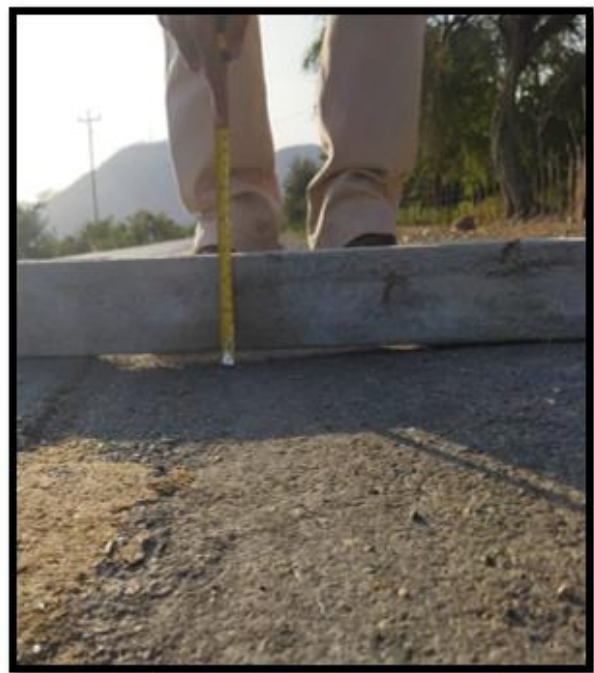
Toma fotográfica de la falla Tipo Abultamiento y Hundimiento en el pavimento en estudio.
